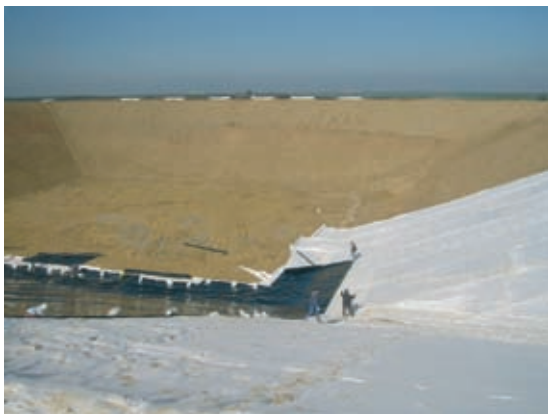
Elementos de una pantalla de impermeabilización
